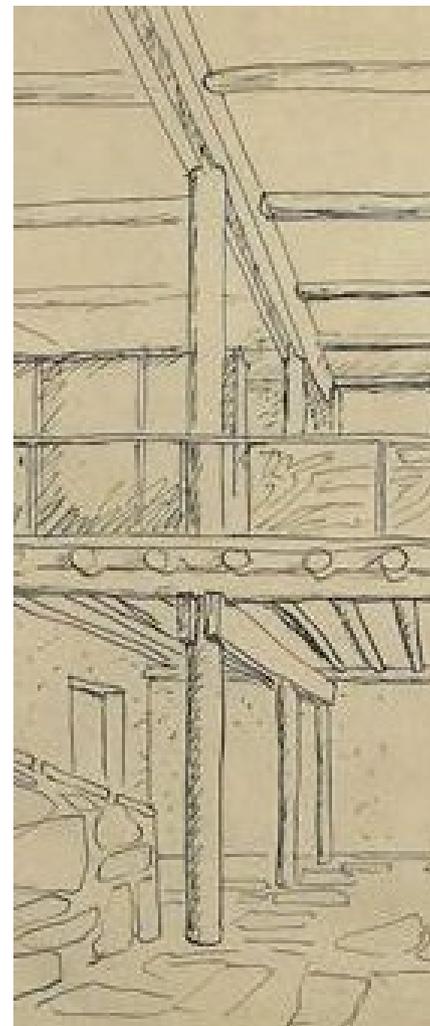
Detalle de ensamble de estructuras de madera. Casa Errázuriz
